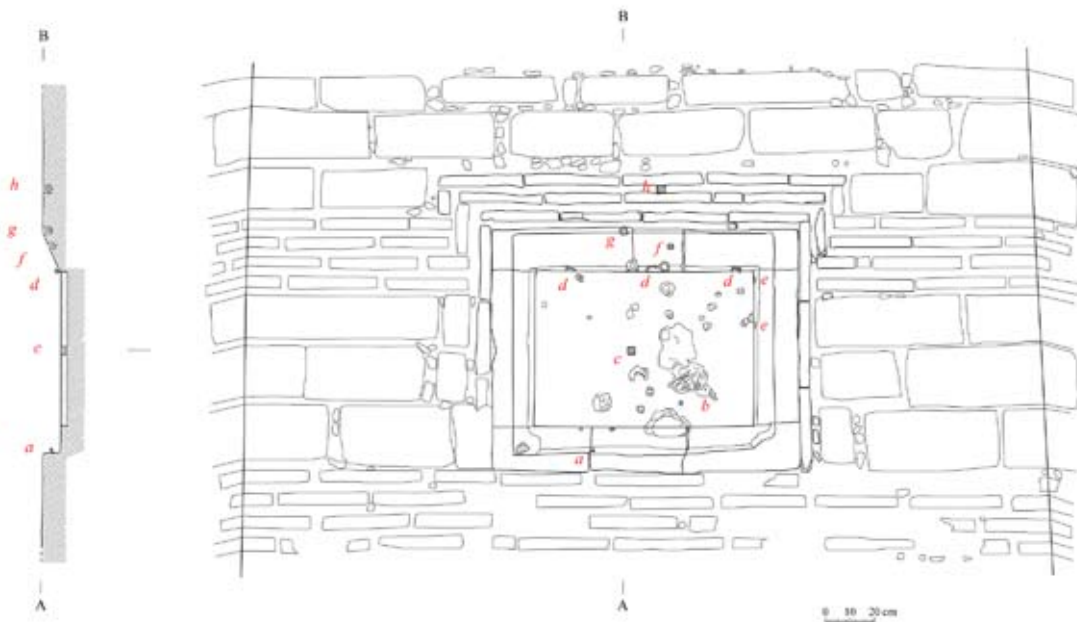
План та розріз мармурової плити на південно-східній грані фасаду вежі № 11 з умовними позначеннями
